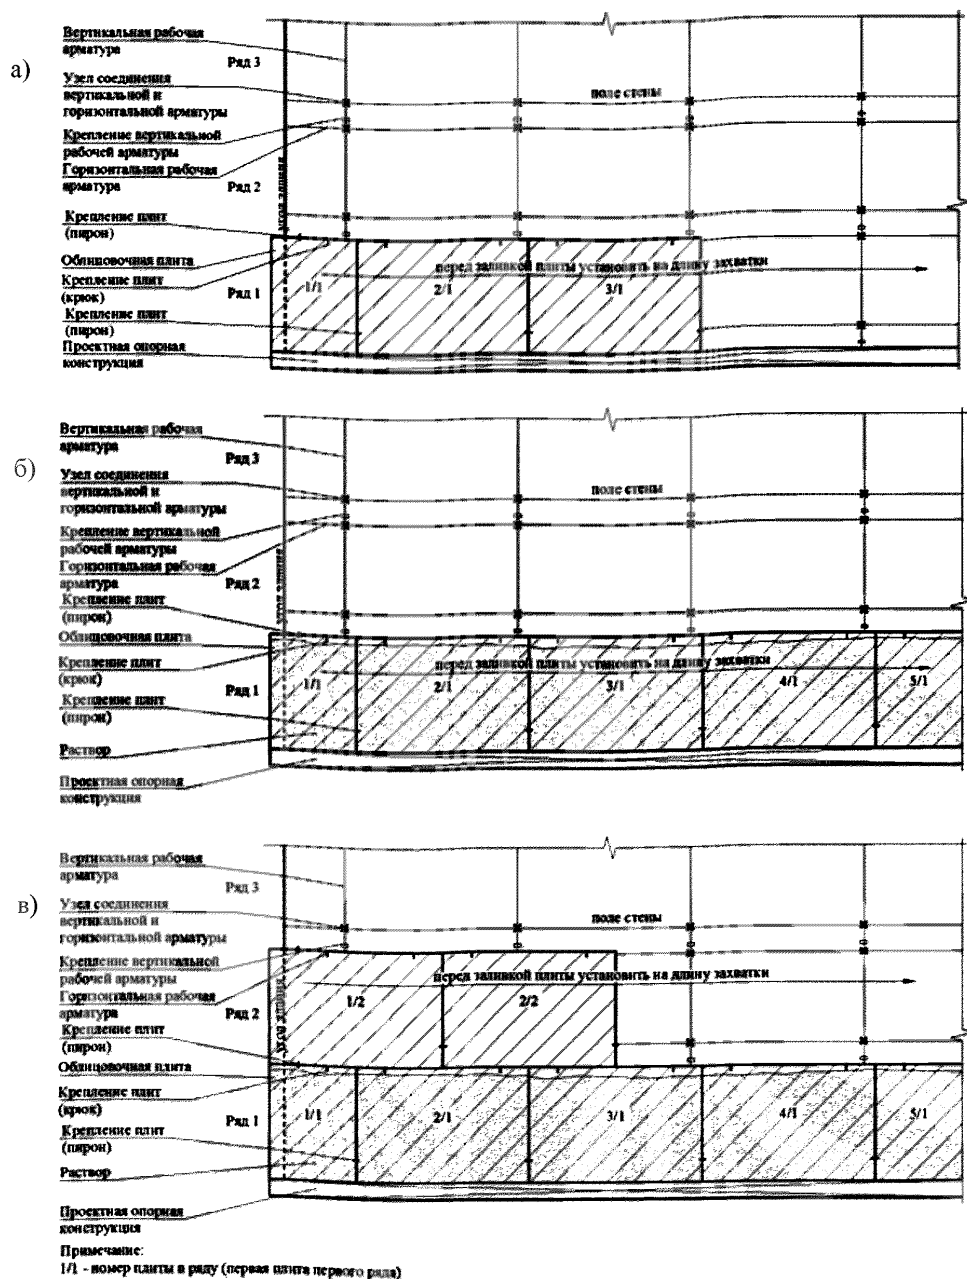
Порядок монтажа облицовочных плит на длину захватки (тип 3)
